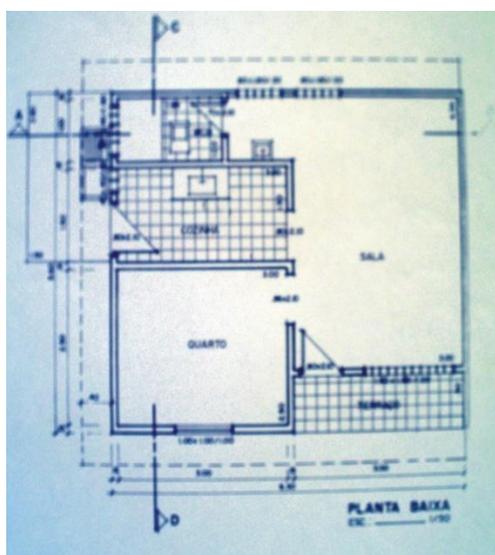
Planta de casa implantada no Conjunto Joaquim Leão.
